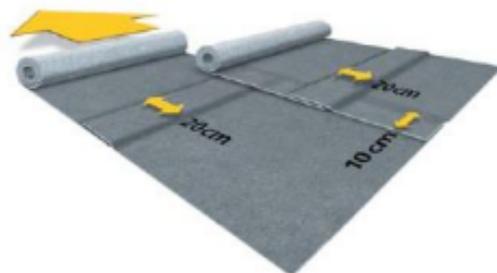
Sobreposição longitudinal e transversal de geotêxtil para impregnação com betume (imagem Fibertex Nonwovens).
